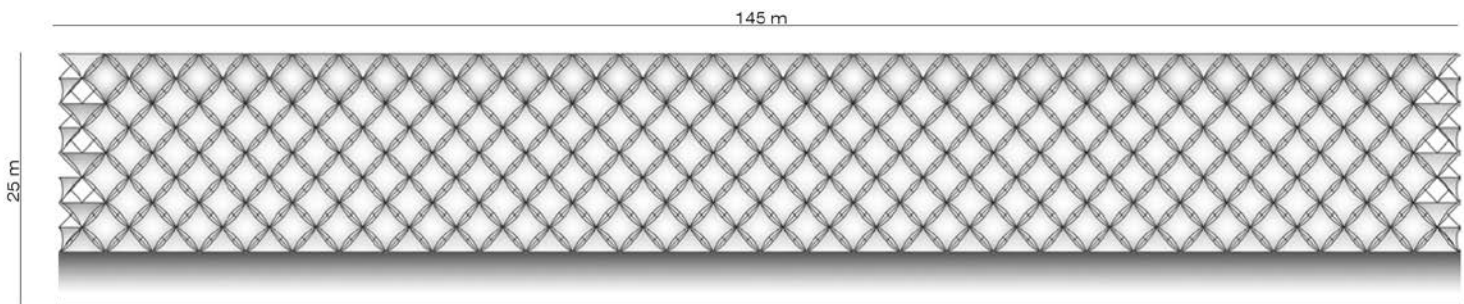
Schema tipo delle facciate (©Gerber Architekten - picture: Christian Richters)
